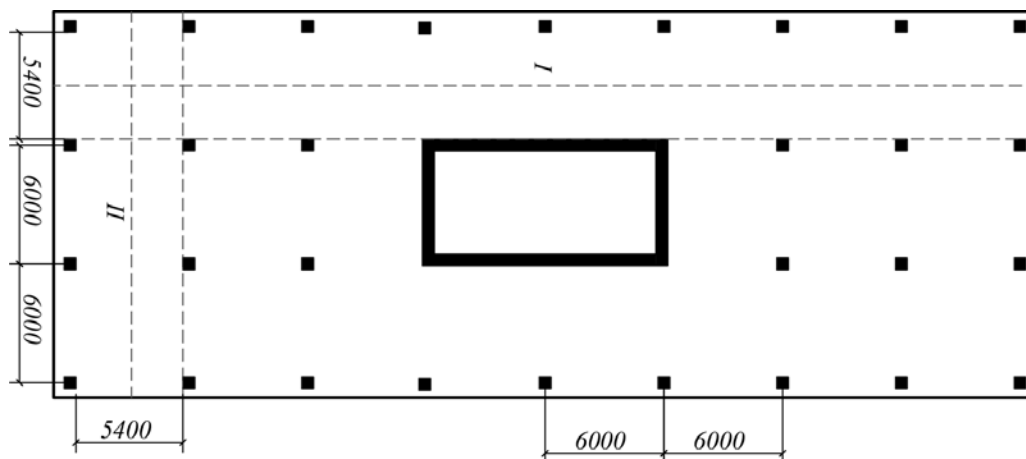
Механизмы разрушения фундаментной плиты
